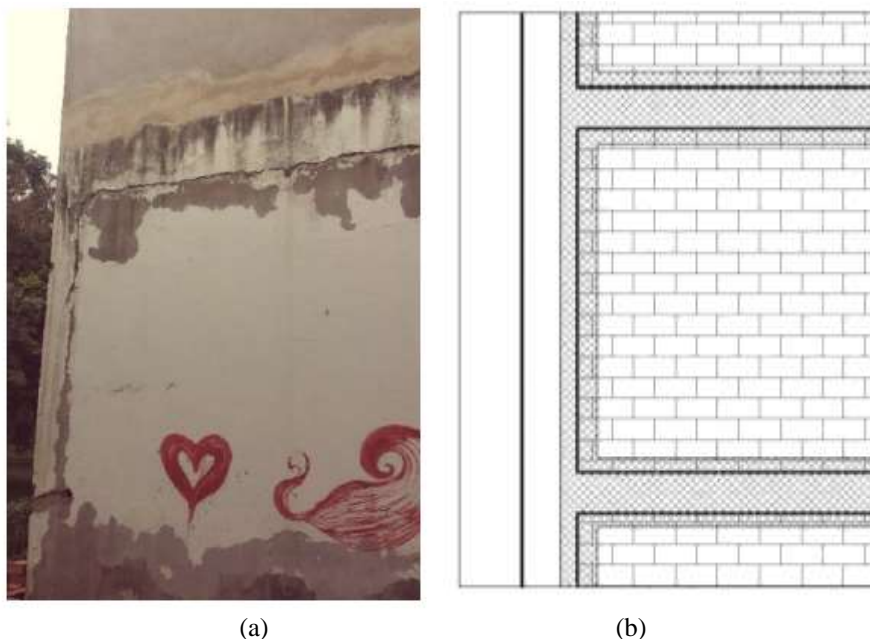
a) Fachada Nordeste. Trincas horizontal e vertical, b) Ilustração da aplicação da tela eletrosoldada (arquivo pessoal)
